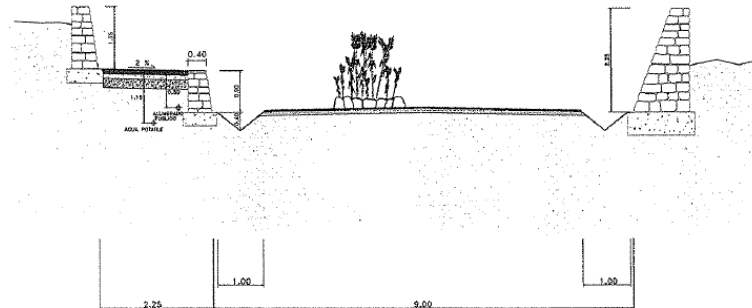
Extracto del plano 13.2 de secciones tipo del proyecto de Encauzamiento Barranco La Cala Fase I, en Finestrat
